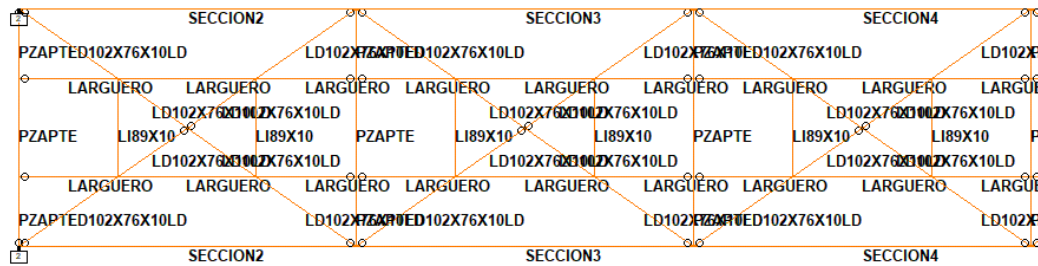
Vista en planta de la cuerda inferior del modelo de la armadura con secciones (media armadura)
